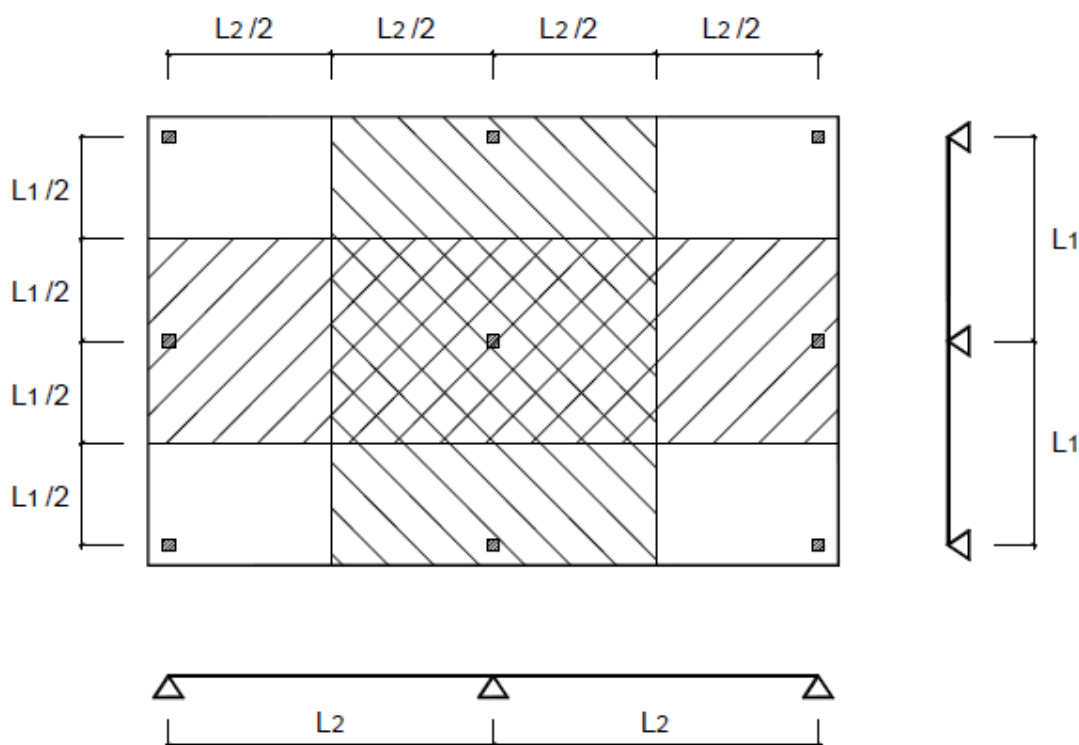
Divisão da laje em pórticos ortogonais independentes (Costa 2013)
